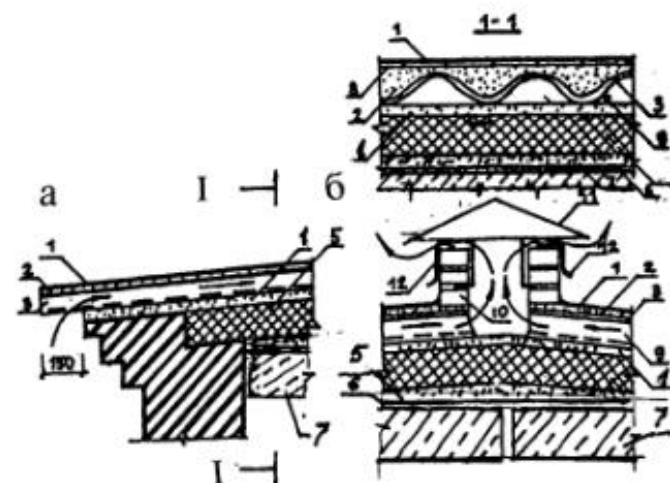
Переустройство невентилируемой совмещенной крыши в вентилируемую: а - карнизный узел, б - коньковый узел; 1 - рулонный гидроизоляционный ковер, 2 - стяжка, 3 - волнистый асбестоцементный лист, 4 - увеличенный слой утеплителя, 5 - отсыпка по уклону, 6 - пароизоляция, 7 - настил перекрытия, 8 - арматурная сетка, 9 - вентиляционный канал, 10 - стенка канала, 11 - зонт из кровельной стали, 12 - фартук
